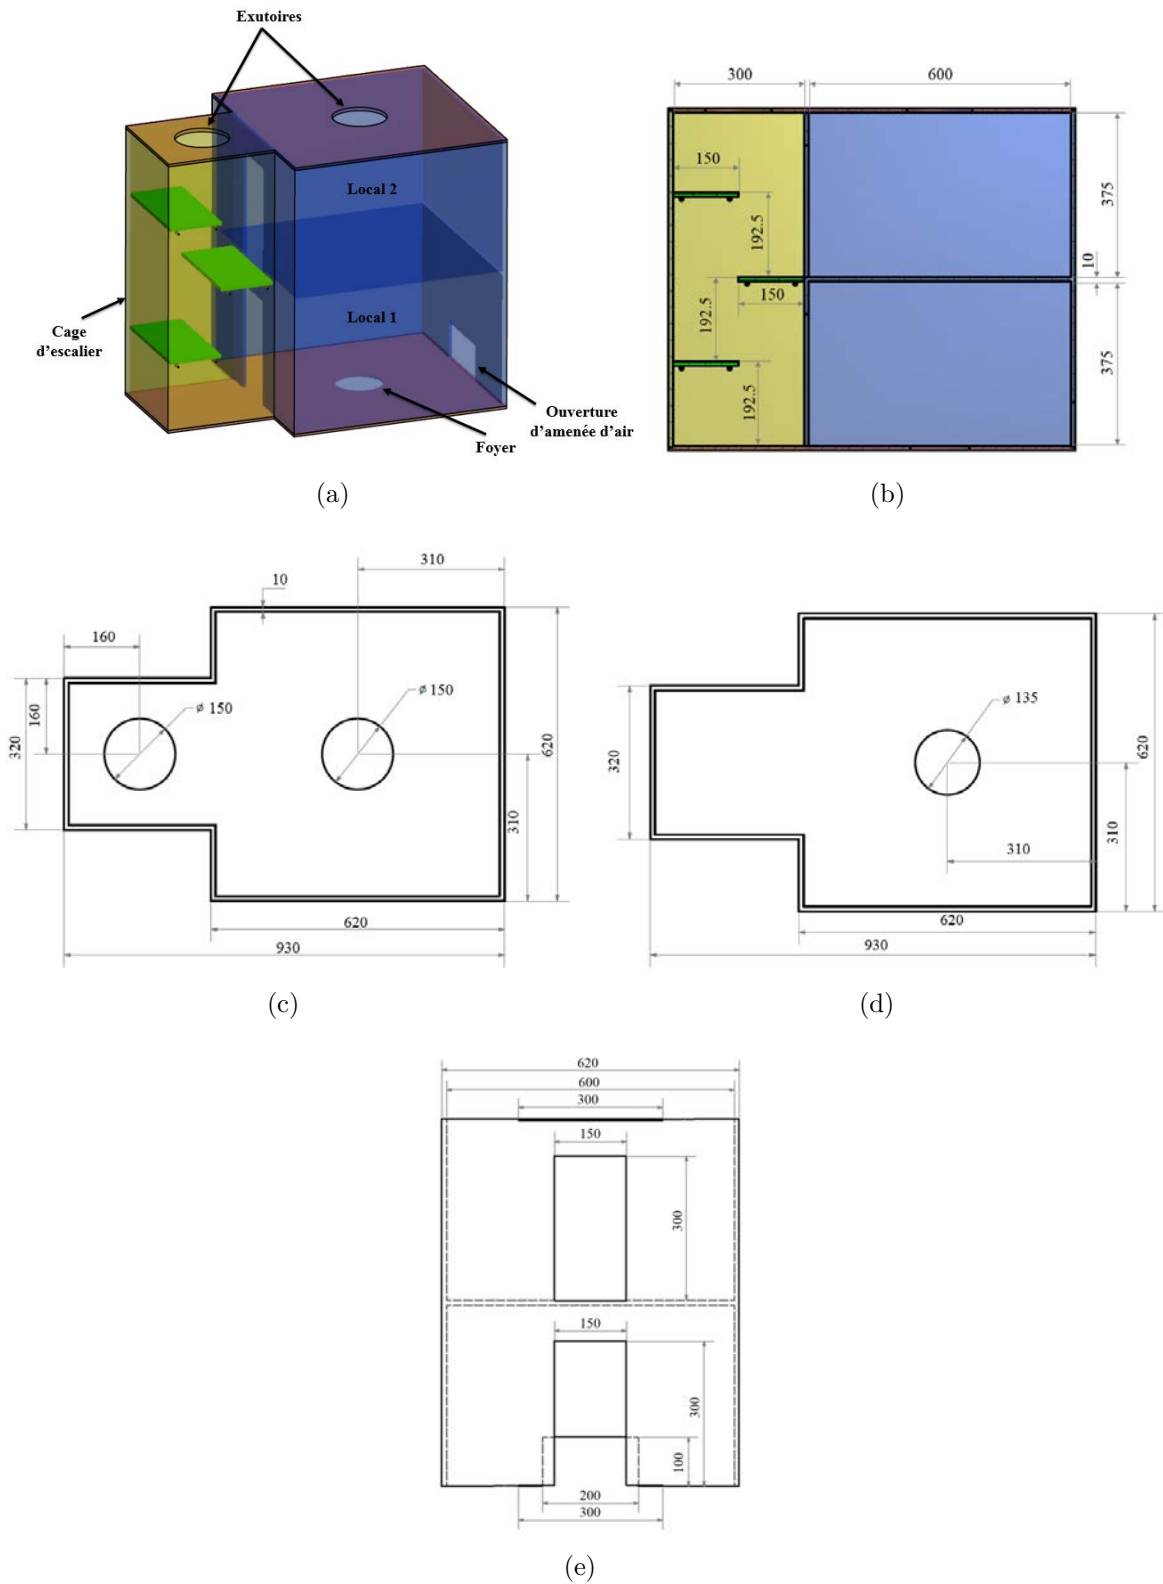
Dimensions de la maquette à deux étages. (a) Représentation 3D, (b) Coupe verticale passant par la cage d'escalier et les deux locaux, (c) Plafond, (d) Plancher, (e) Coupe verticale passant entre la cage d'escalier et les deux locaux. (Les dimensions sont en (mm)).
